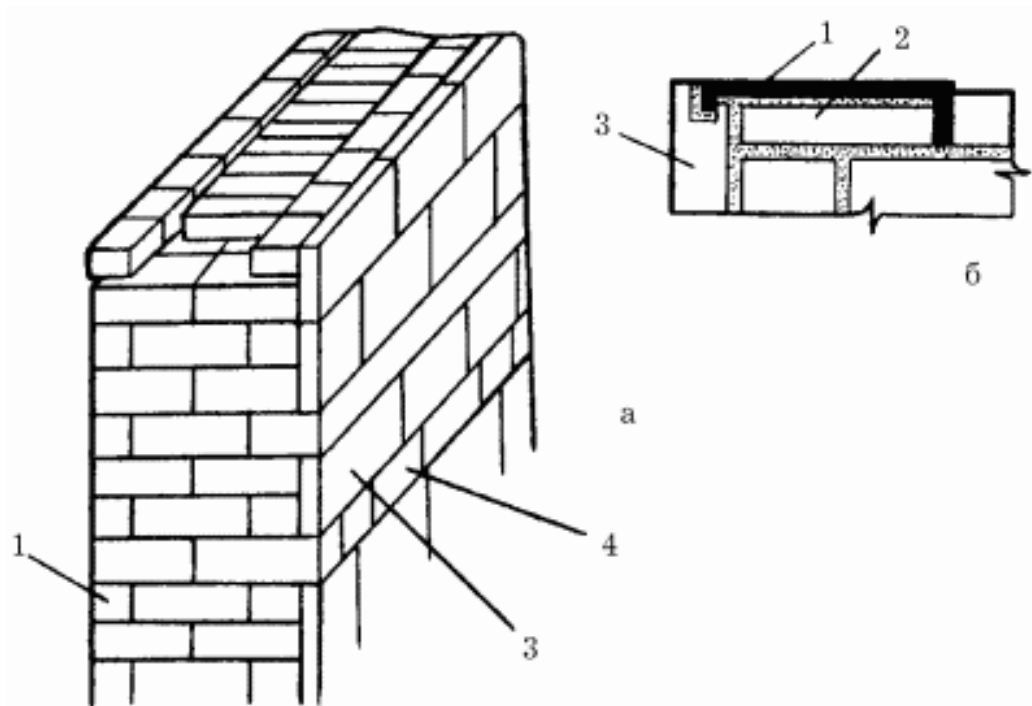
Кладка стен с одновременной облицовкой силикатными или керамическими плитами: а – общий вид; б – фрагмент кладки: 1 – анкер; 2 – пирон; 3 – прислонные облицовочные плиты; 4 – прикладной ряд плит.
